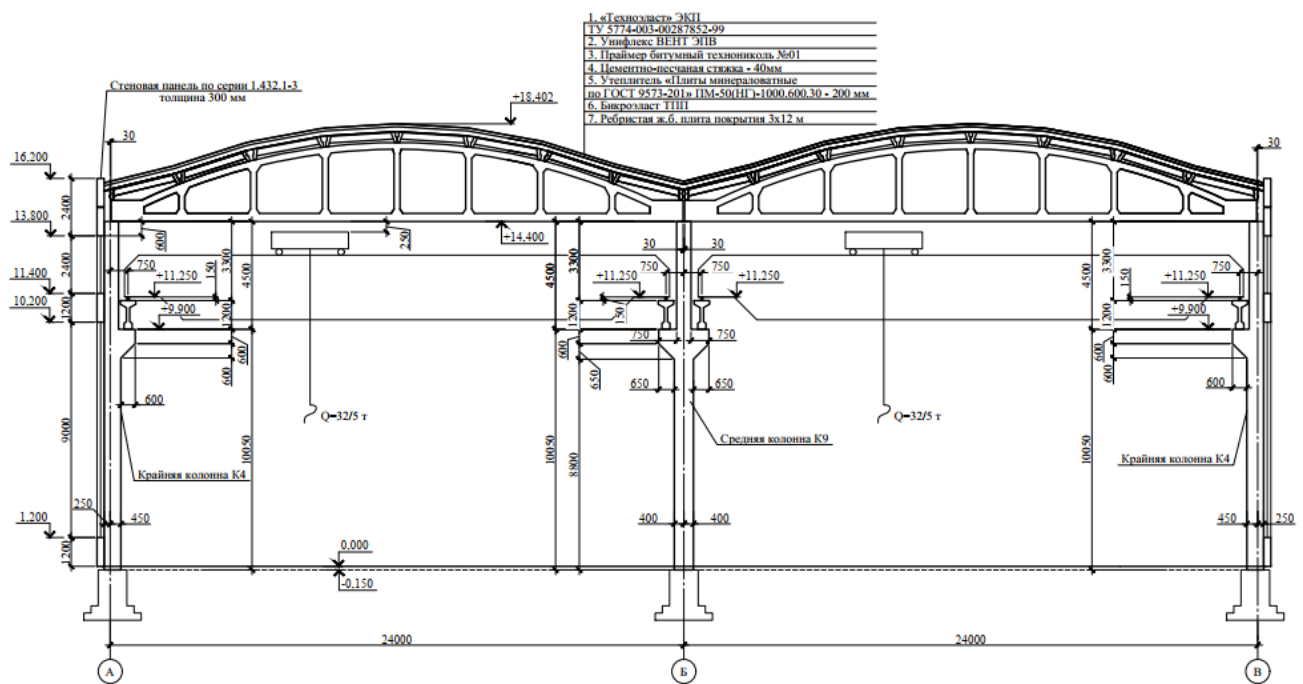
Поперечная рама одноэтажного промышленного здания с мостовыми кранами
